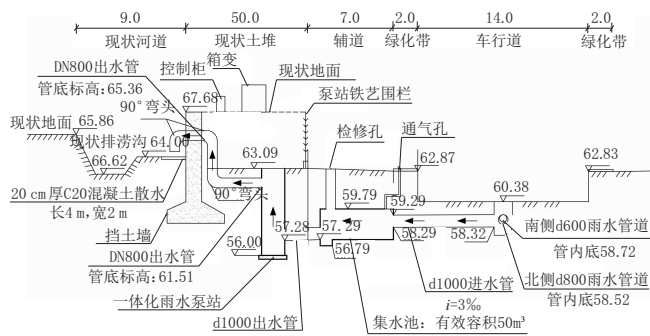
冯北路下穿铁路雨水泵站剖面图(单位:m)
